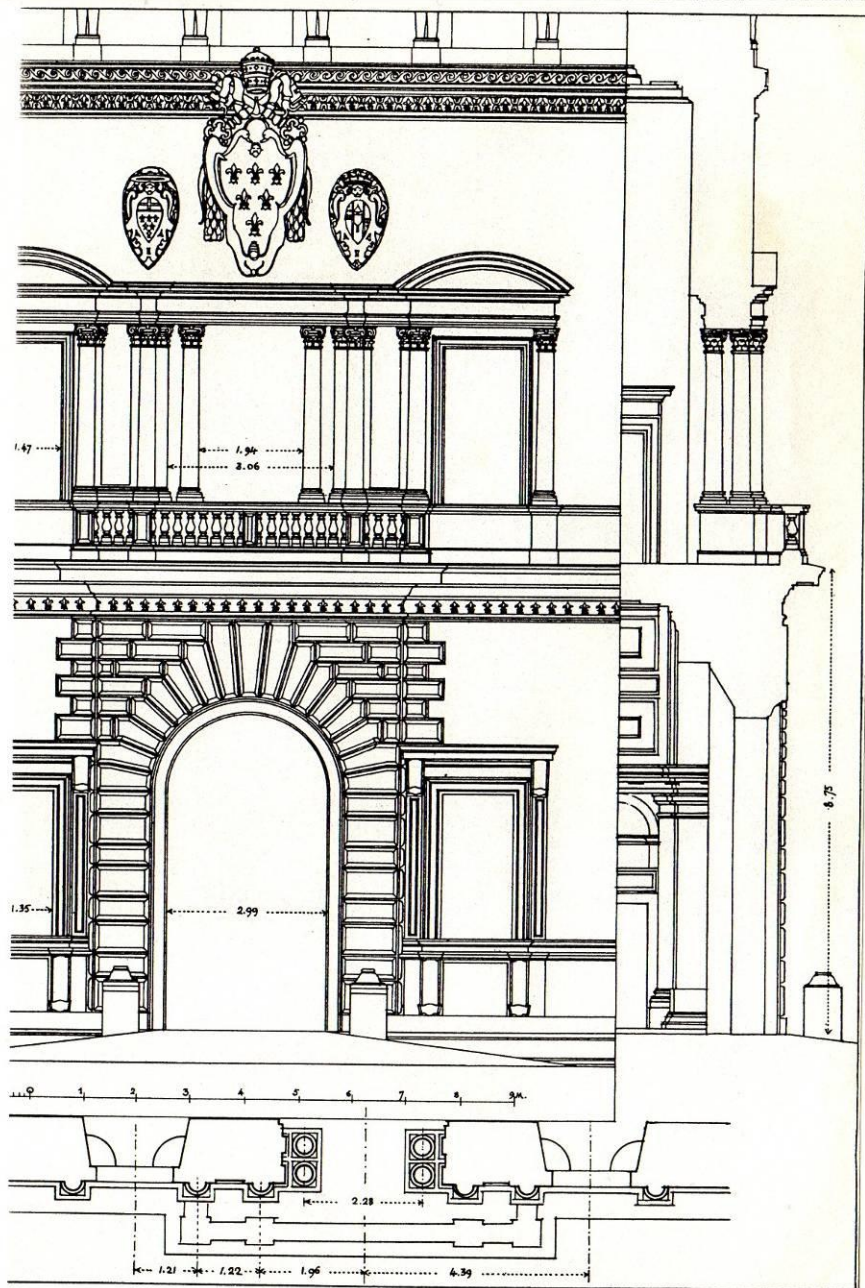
/212: PLAN, COUPE ET ÉLEVATION DE L'ENTRÉE PRINCIPALE du Palais Farnèse.
